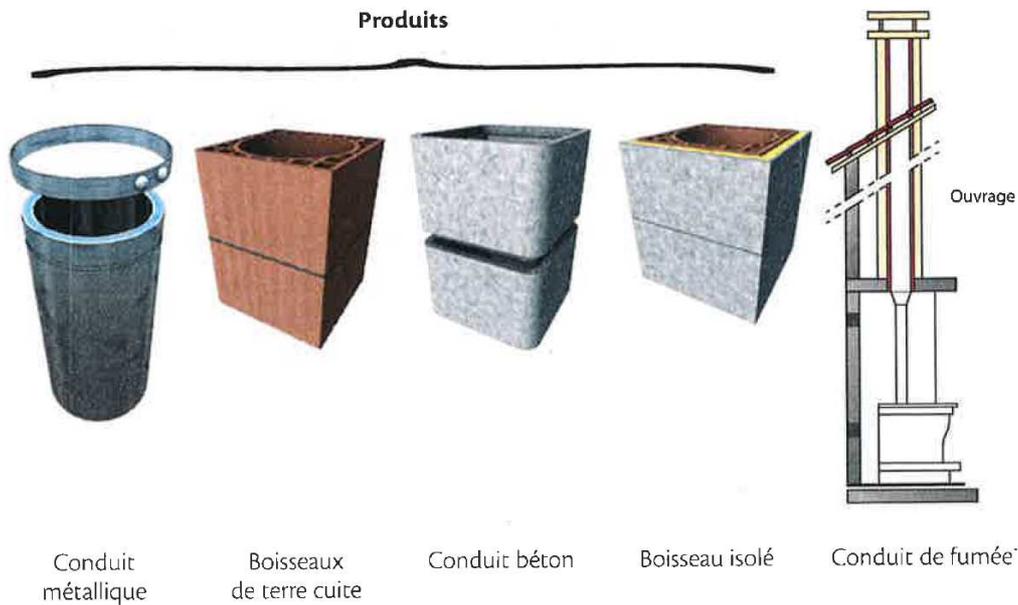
Produits « conduit de fumée » et Ouvrage « conduit de fumée »
